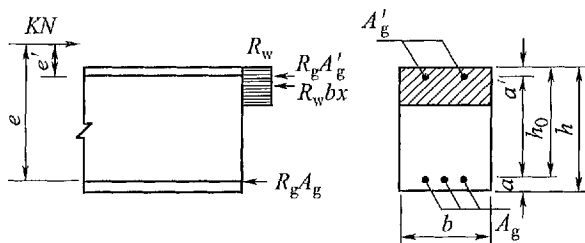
钢筋混凝土大偏心受压构件截面强度计算
